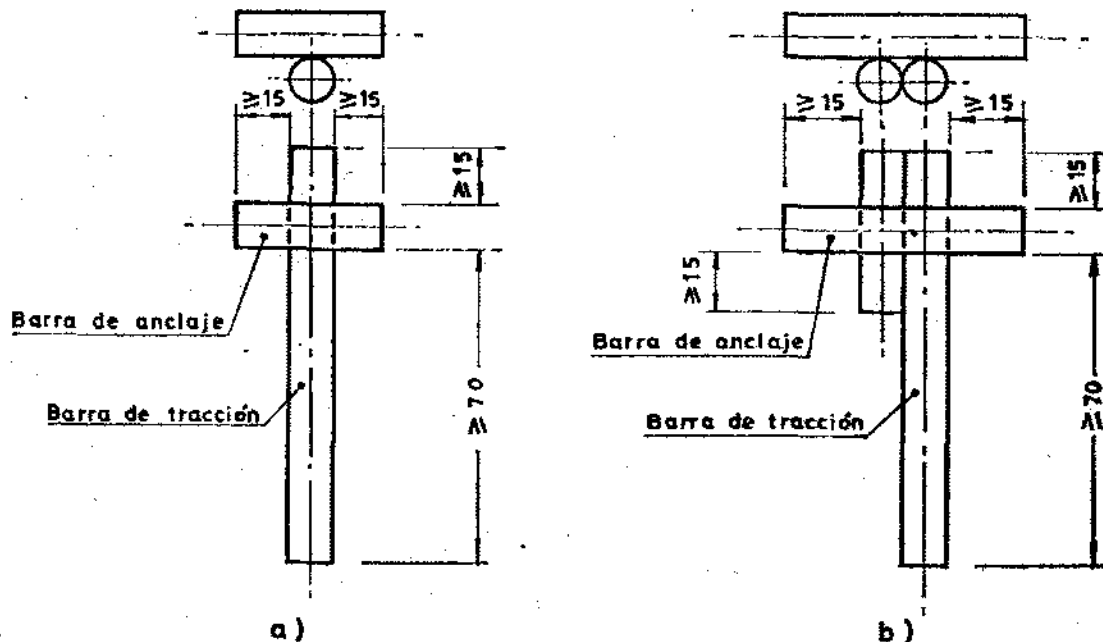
Probetas para ensayo de despegue de las barras de nudo en mallas electrosoldadas. a) Para barras aisladas. b) Para barras pareadas (medidas en mm.)
